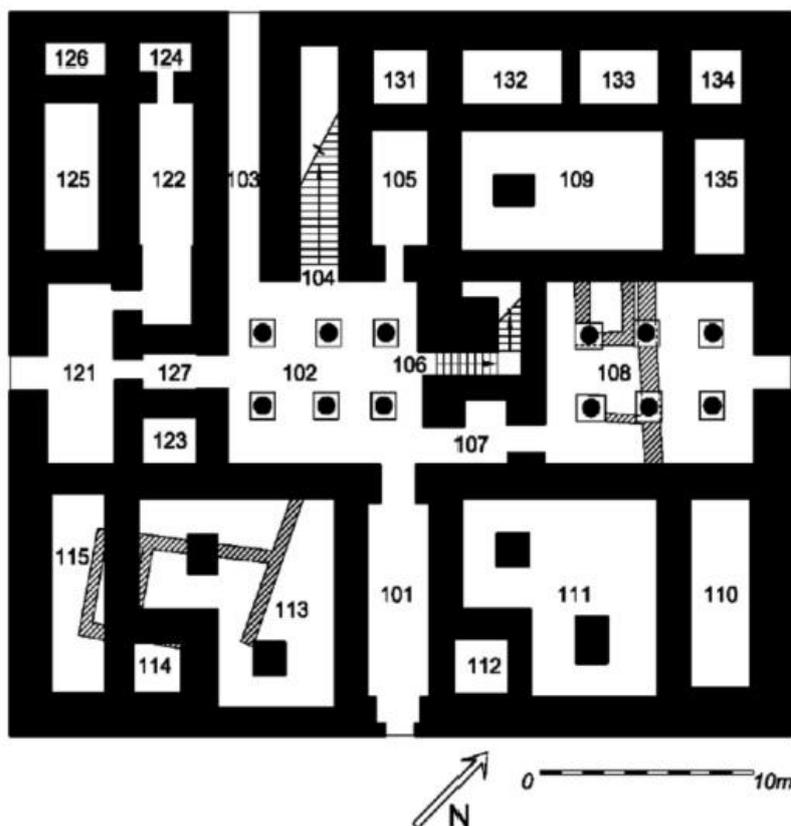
Planta del edificio B100 (KENDALL 2014b: fig. 2).
